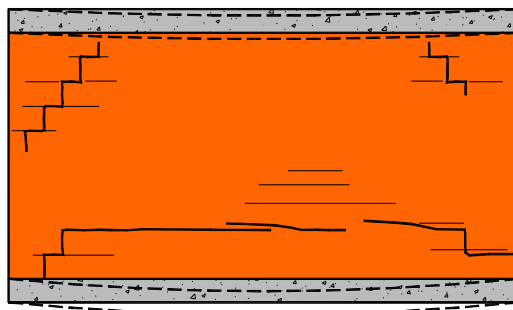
Fissuras em parede de vedação: deformação do suporte maior que a deformação da viga superior [30]
